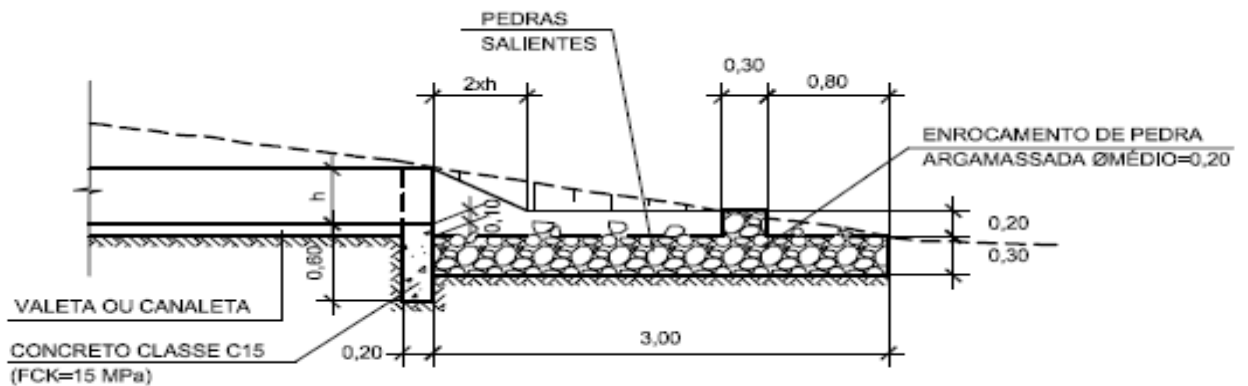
Ilustração da seção planejada para o canal trapezoidal
